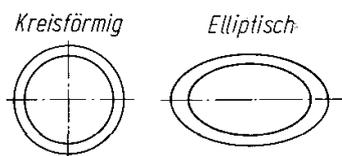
Statisch günstige Querschnittsformen – Idealform [2]
